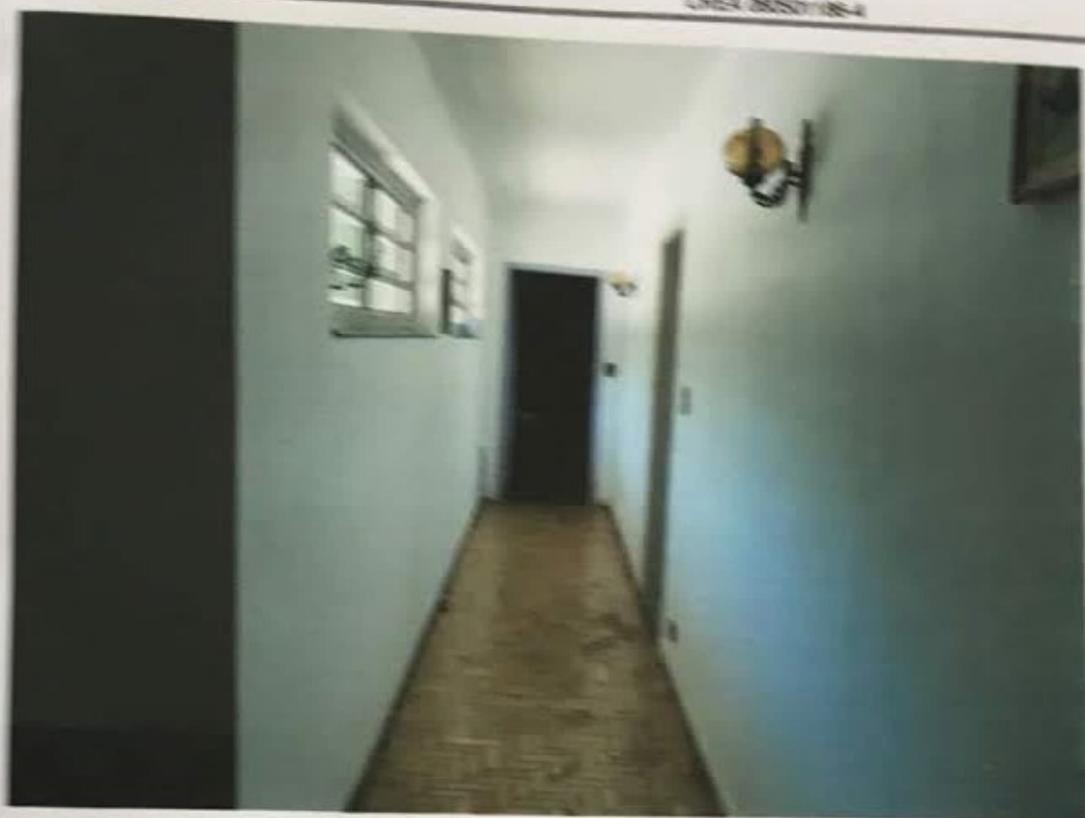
Vista do corredor existente na parte de cima da casa.
